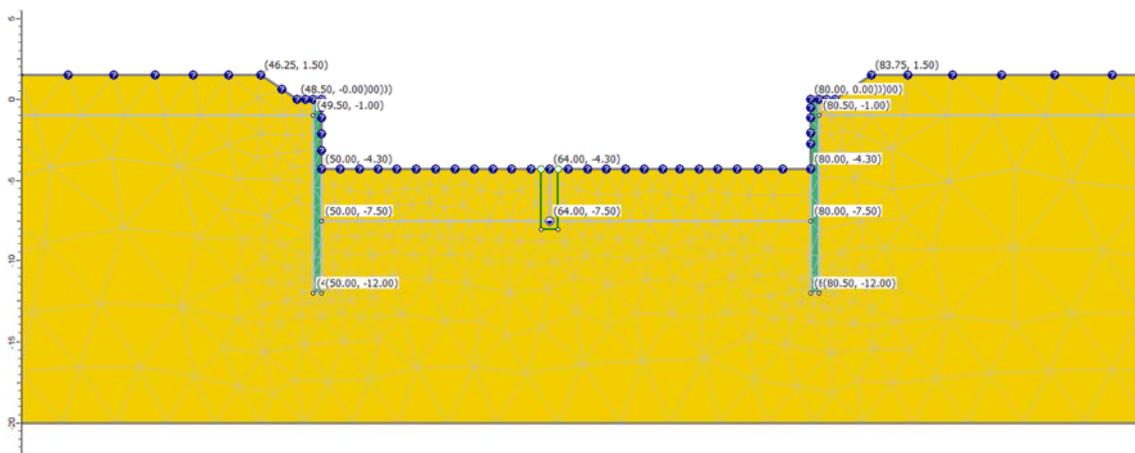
sezione del modello di calcolo nella fase di scavo "completo" fino ad estradosso solettone di fondazione, a seguito dell'installazione del sistema well point
